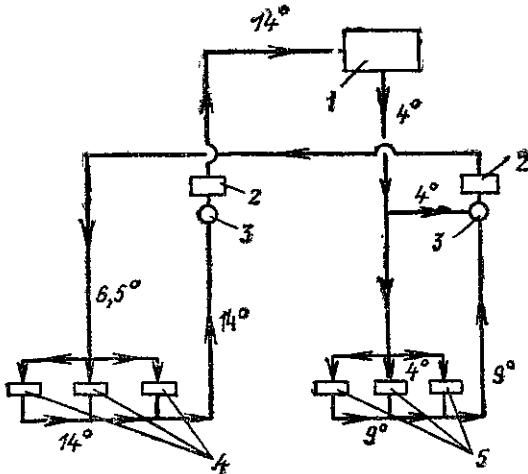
Схема водопровода установки для кондиционирования воздуха
